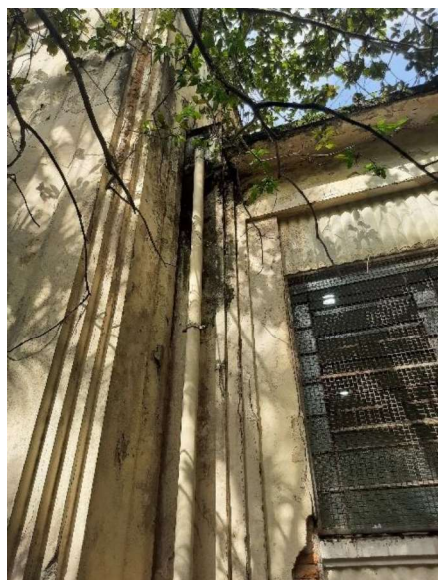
Umidade proveniente da calha. Calha a ser impermeabilizada. Frente do prédio.
